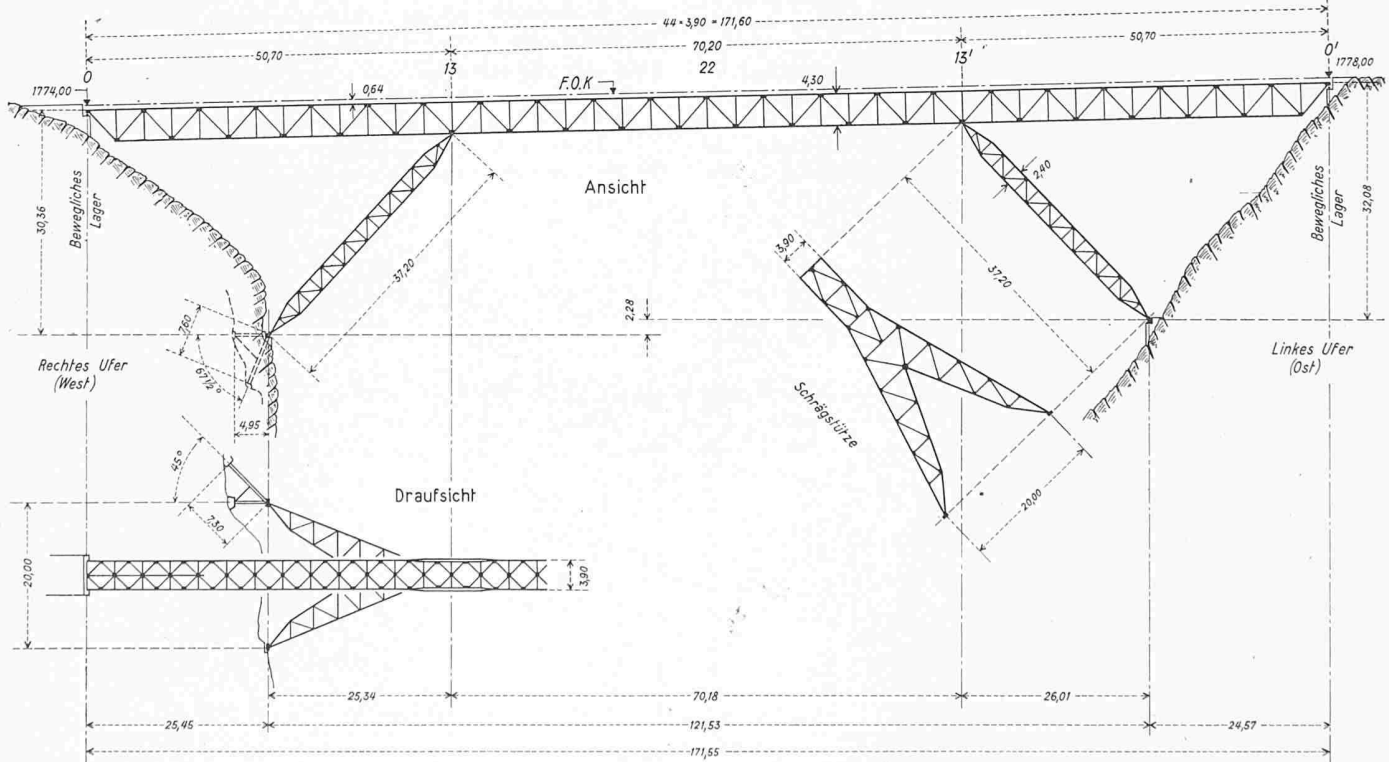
Ubersichtsplan der Brücke, Masstab 1:1000
